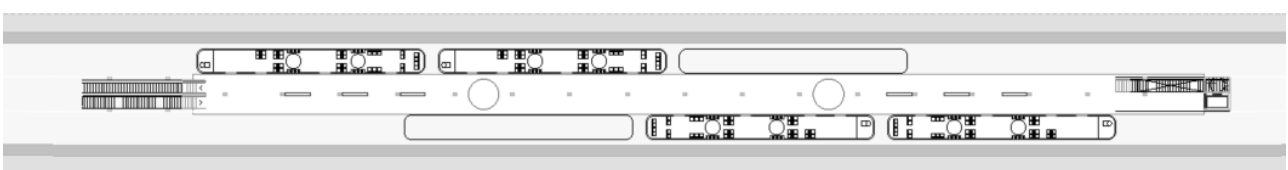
Layout de las paradas dobles (Av. 18 de Julio - soterradas). Fuente: FADU, 2025.
